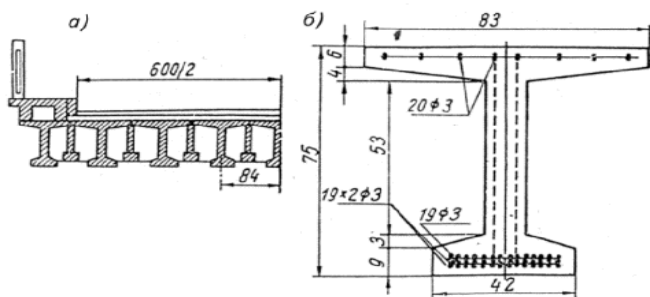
Прольотна будова із струнобетонних попередньо напружених балок:
